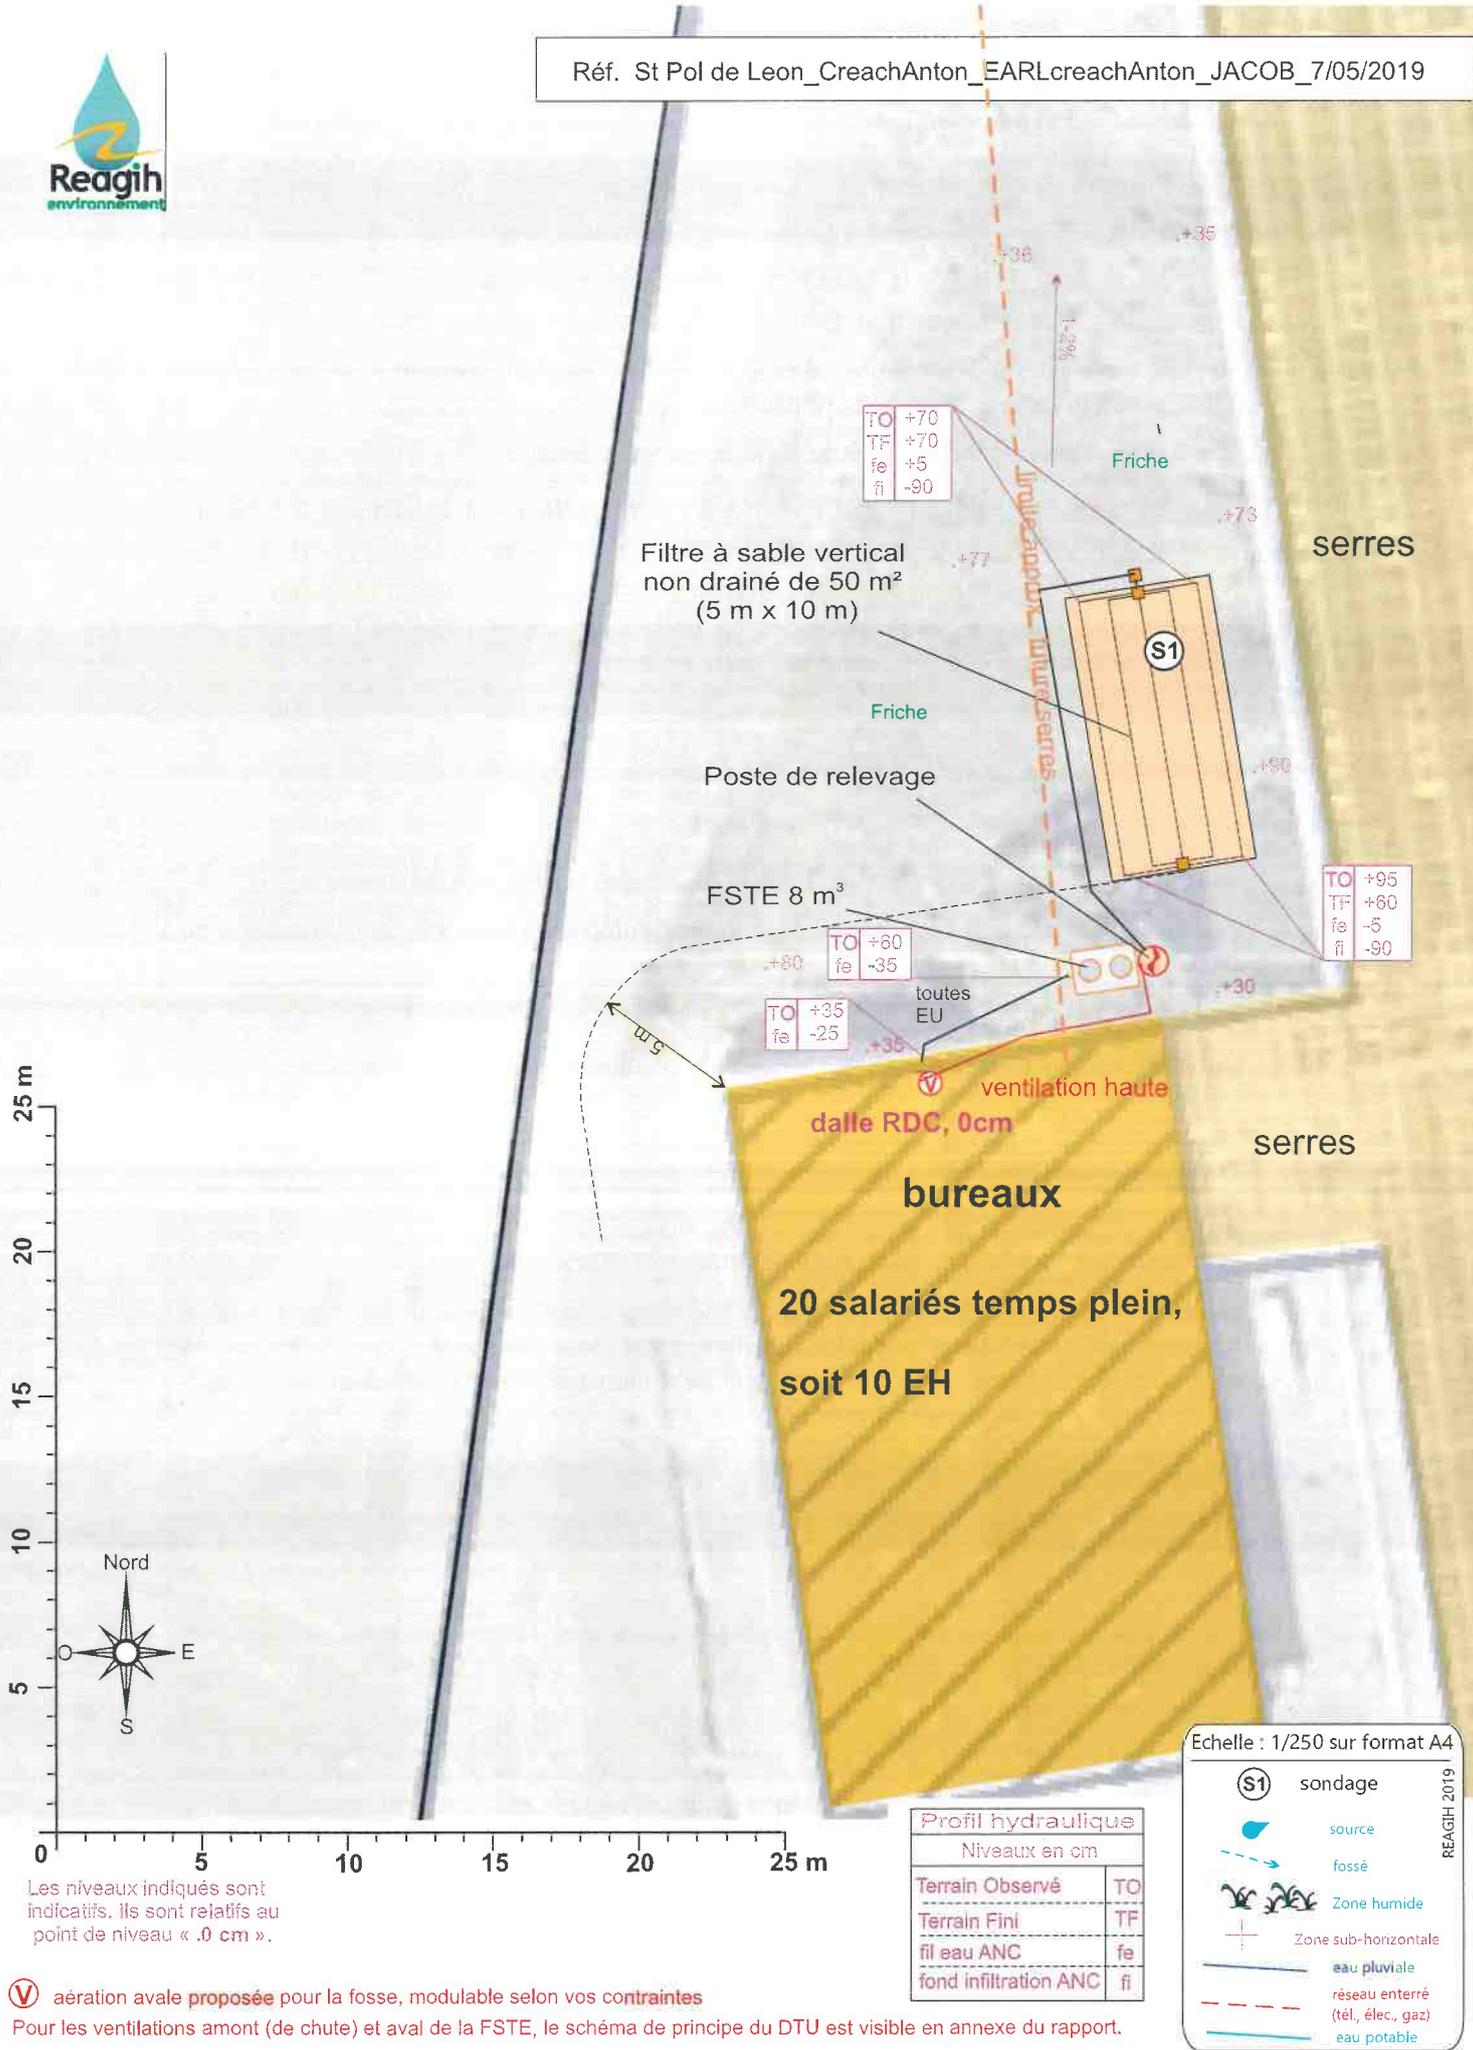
Schéma d'implantation du dispositif d'assainissement et profil hydraulique à plat.
